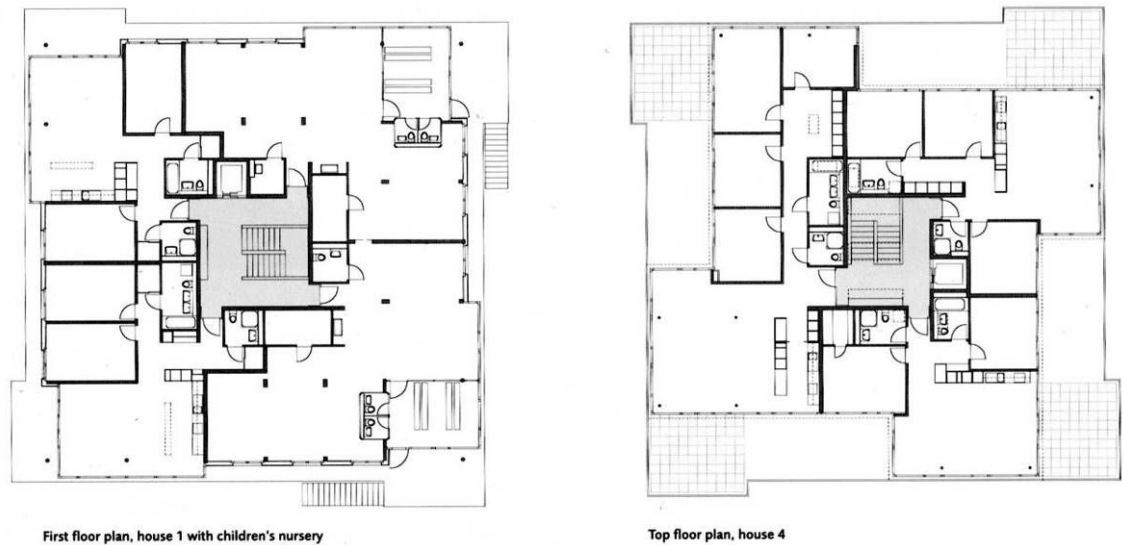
Steinacker Residential Complex de Hasler Schlatter Partner Architekten en Zurich-Witikon. Planta primera con guardería y planta superior.
